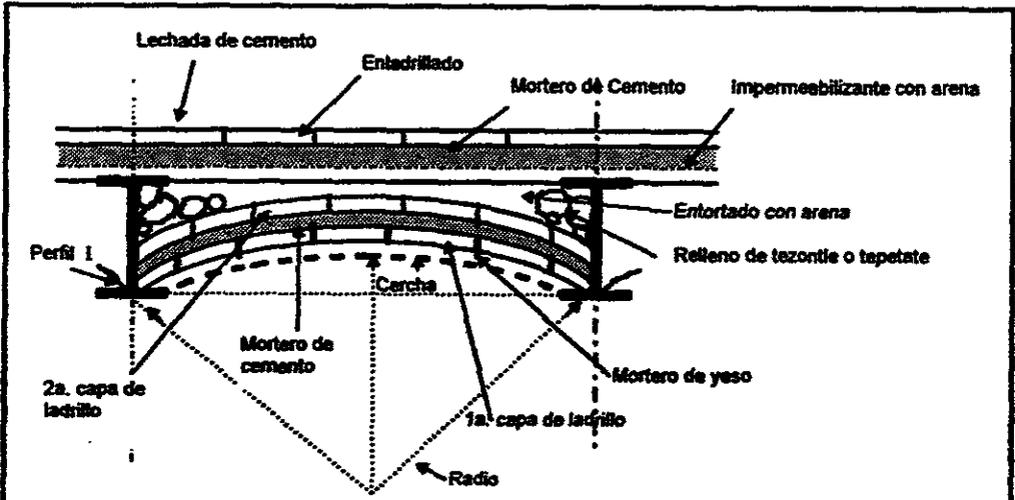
Bóveda escarzana para entrepiso o cubierta.
